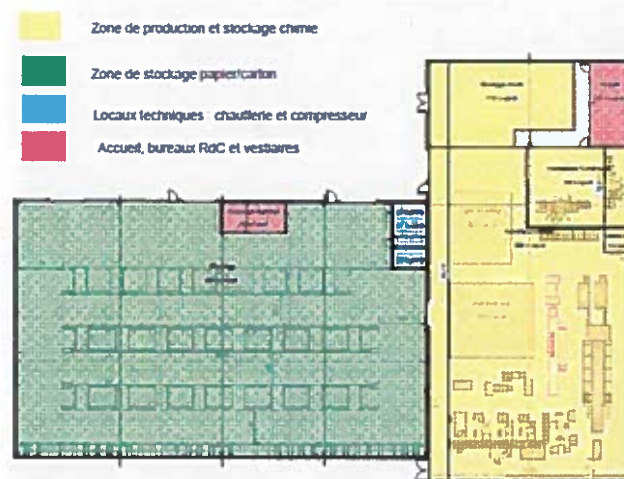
Plan d'aménagement du RDC du site PHOTOBX
